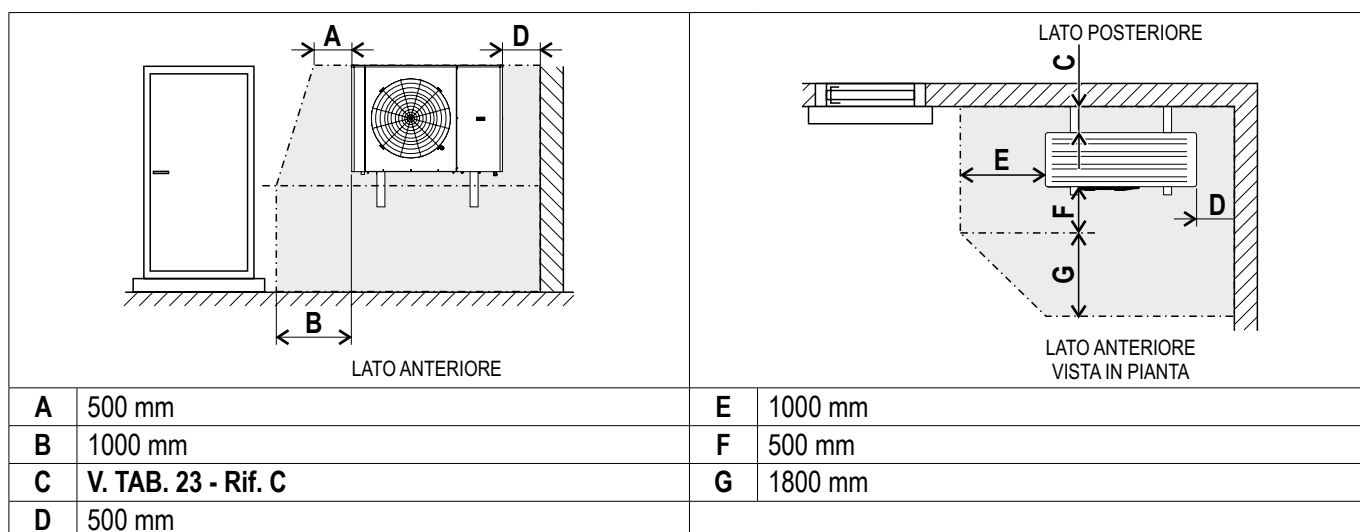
(Zona di sicurezza in caso di installazione a parete in un angolo dell'edificio)
